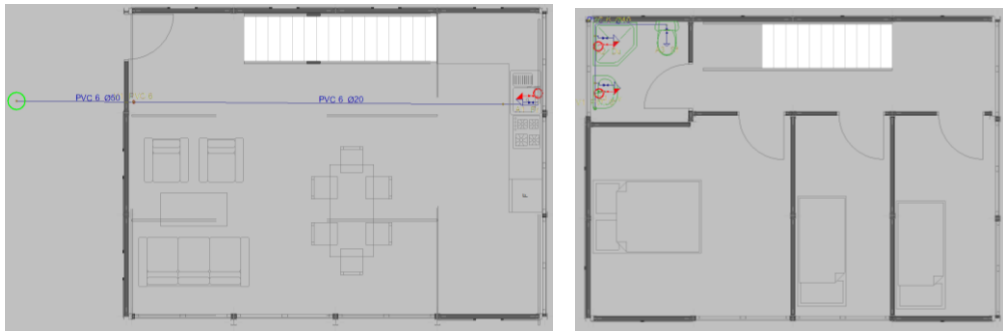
Conexión de fontanería planta baja y alta de la vivienda de 2 plantas, vista 2D
